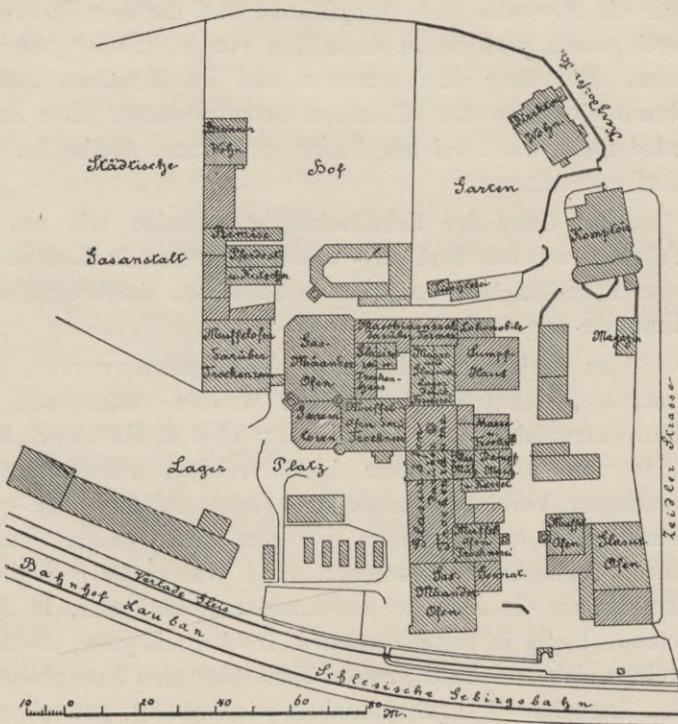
Lageplan der Laubaner Thonwerke in Lauban.
